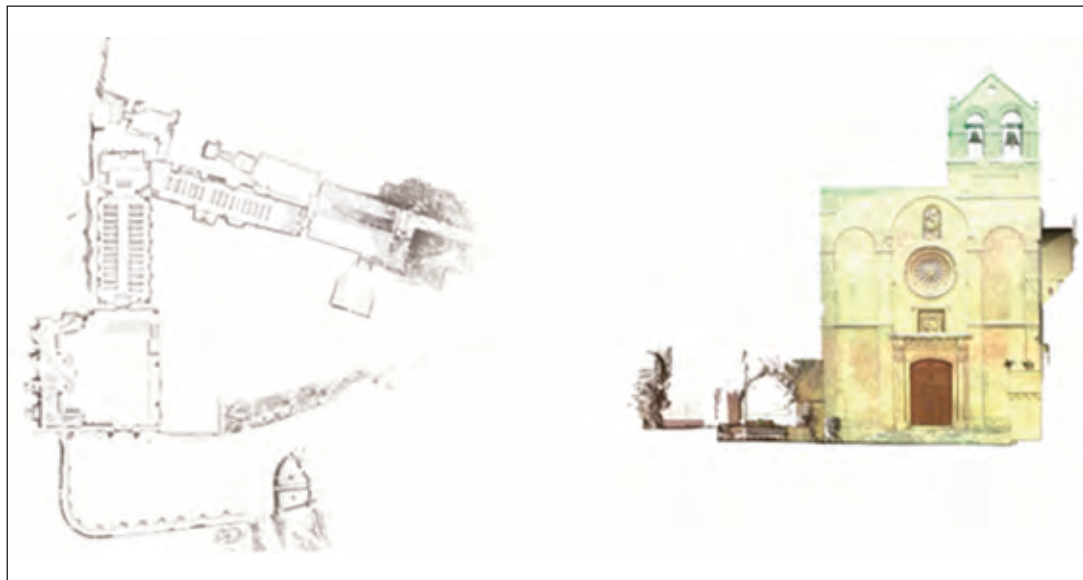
Pianta e prospetto della Chiesa della Palomba.
